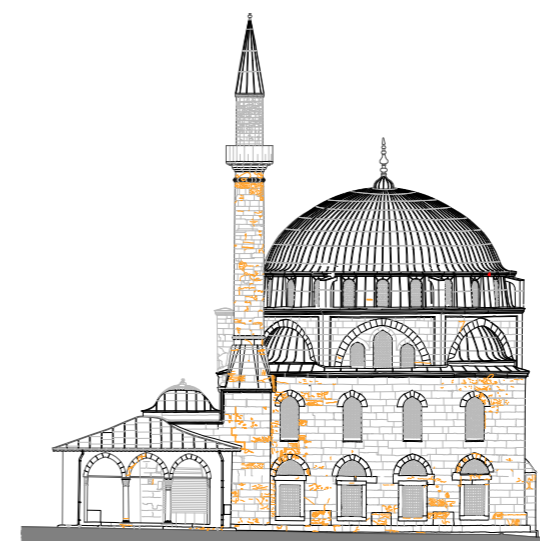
uadro fessurativo prospetto Sud Ovest.pdf
